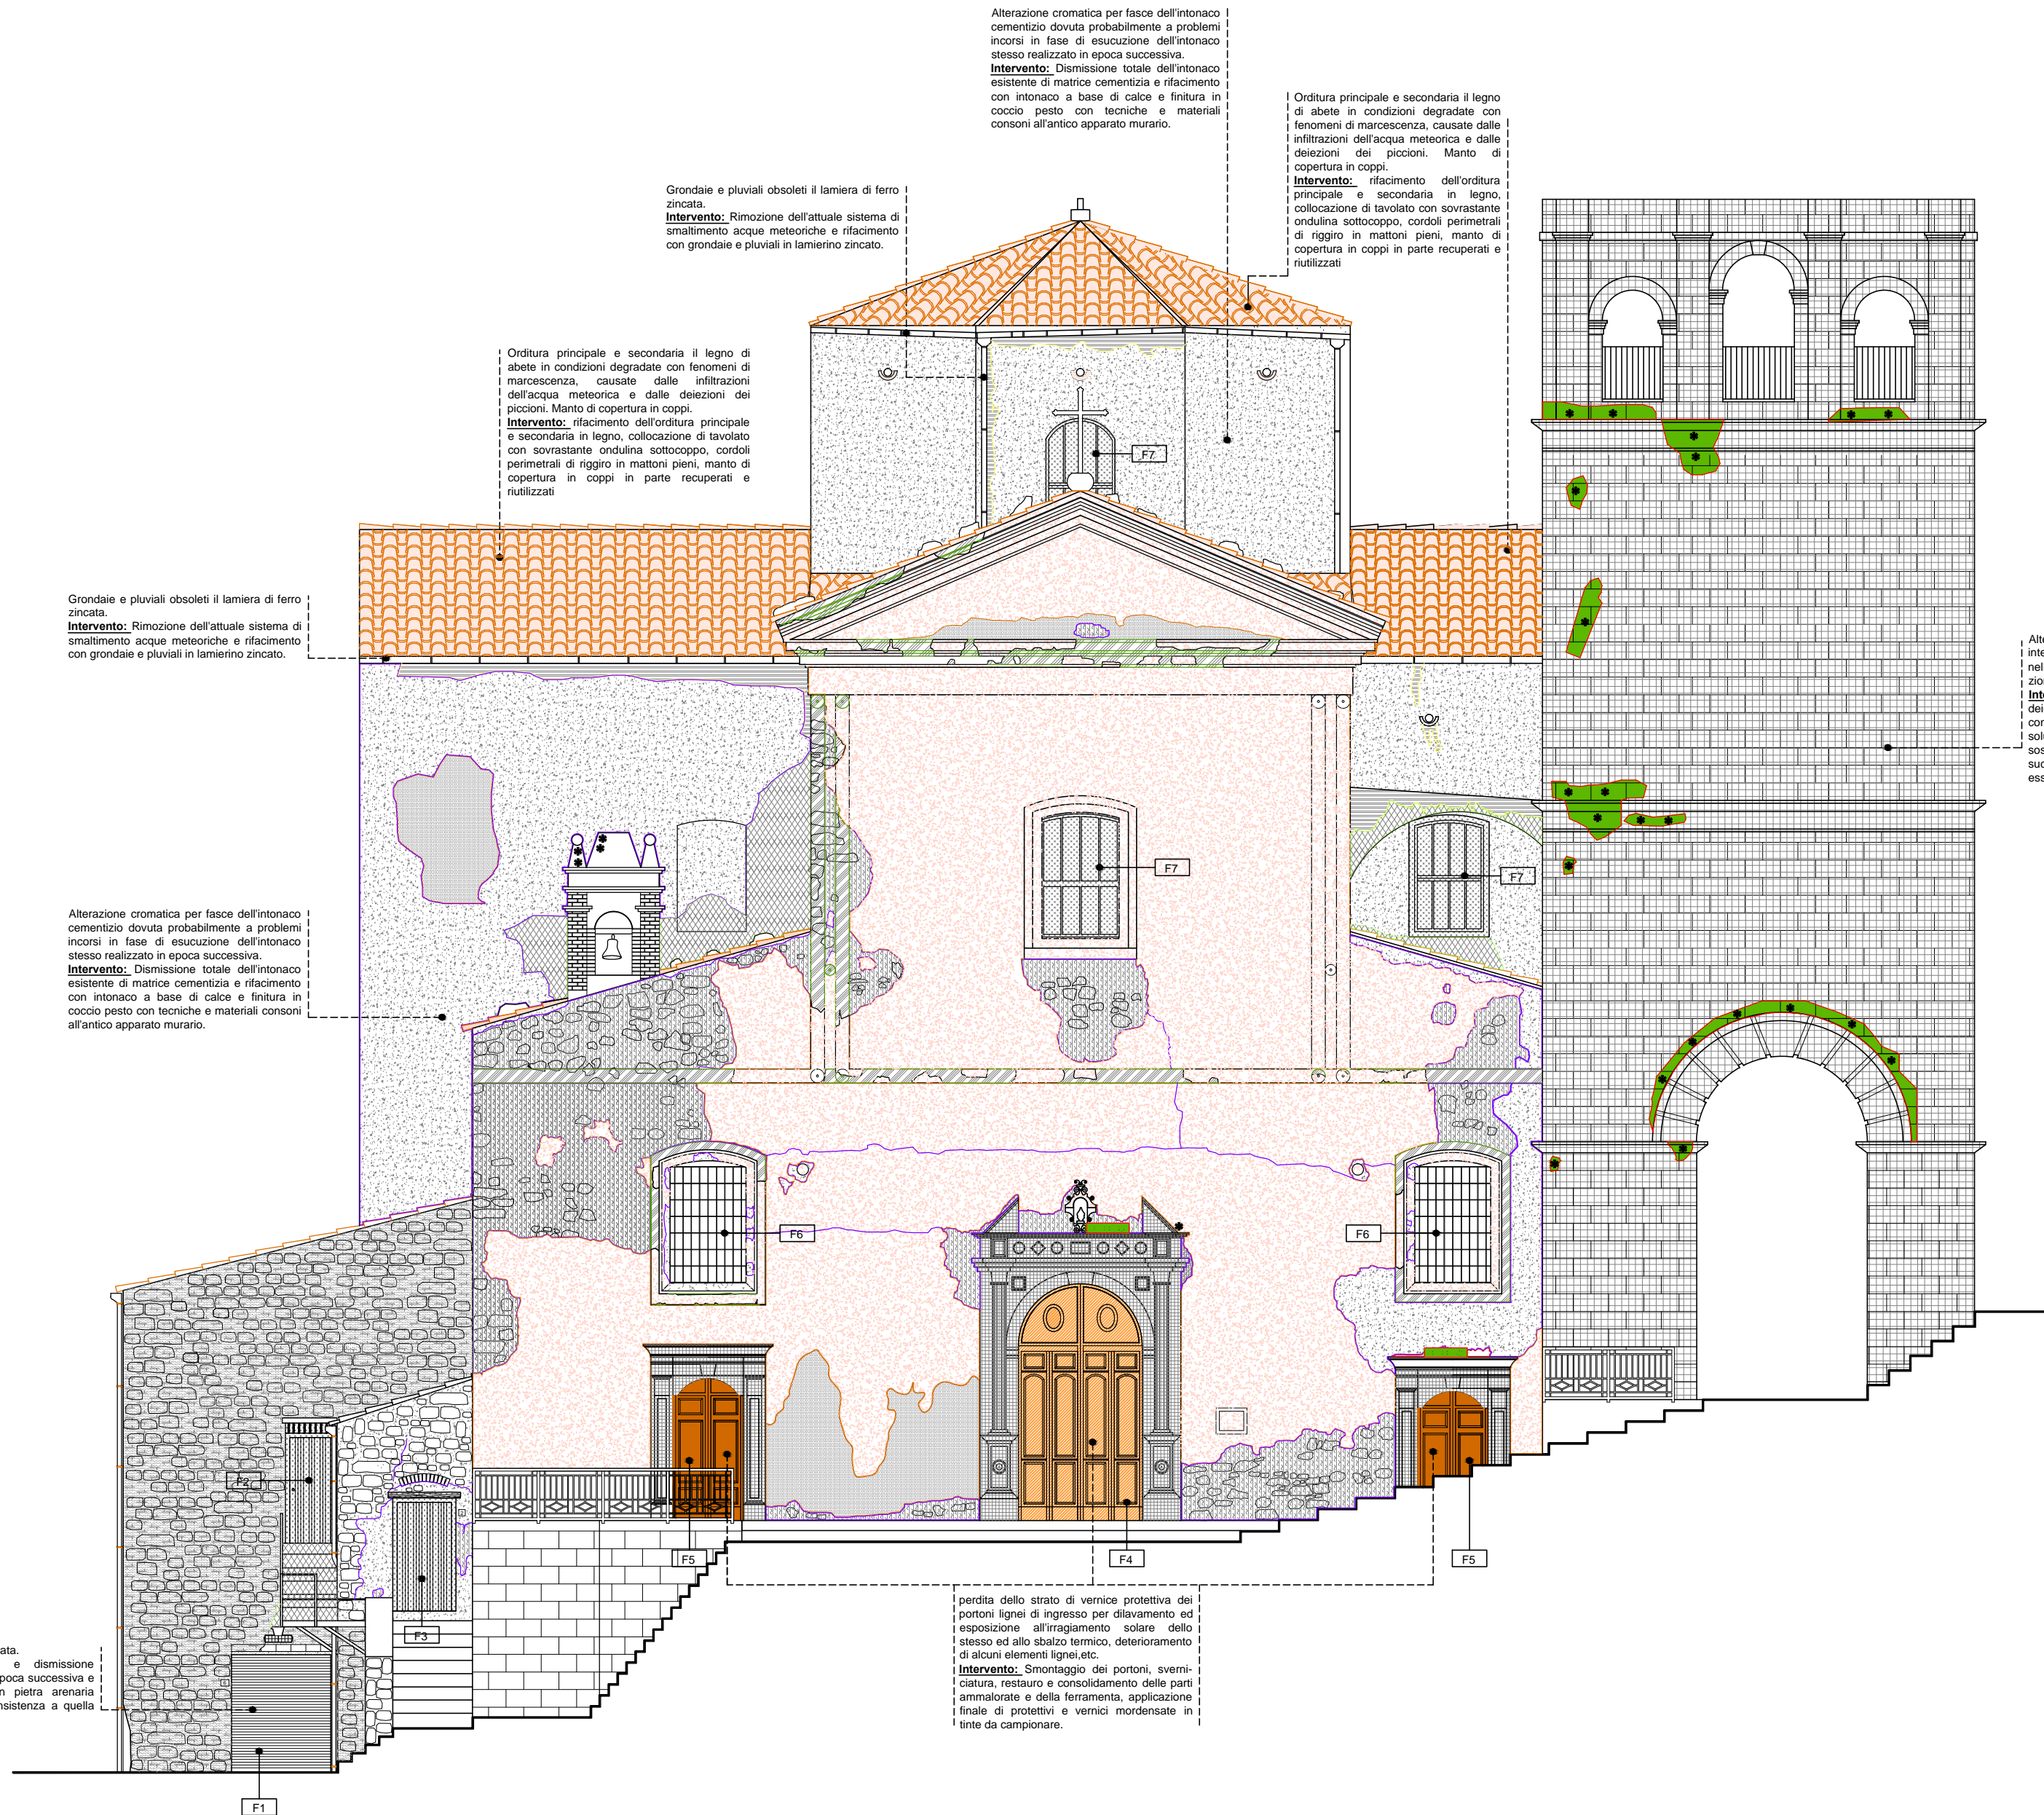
PARTICOLARE DEL PROSPETTO PRINCIPALE
